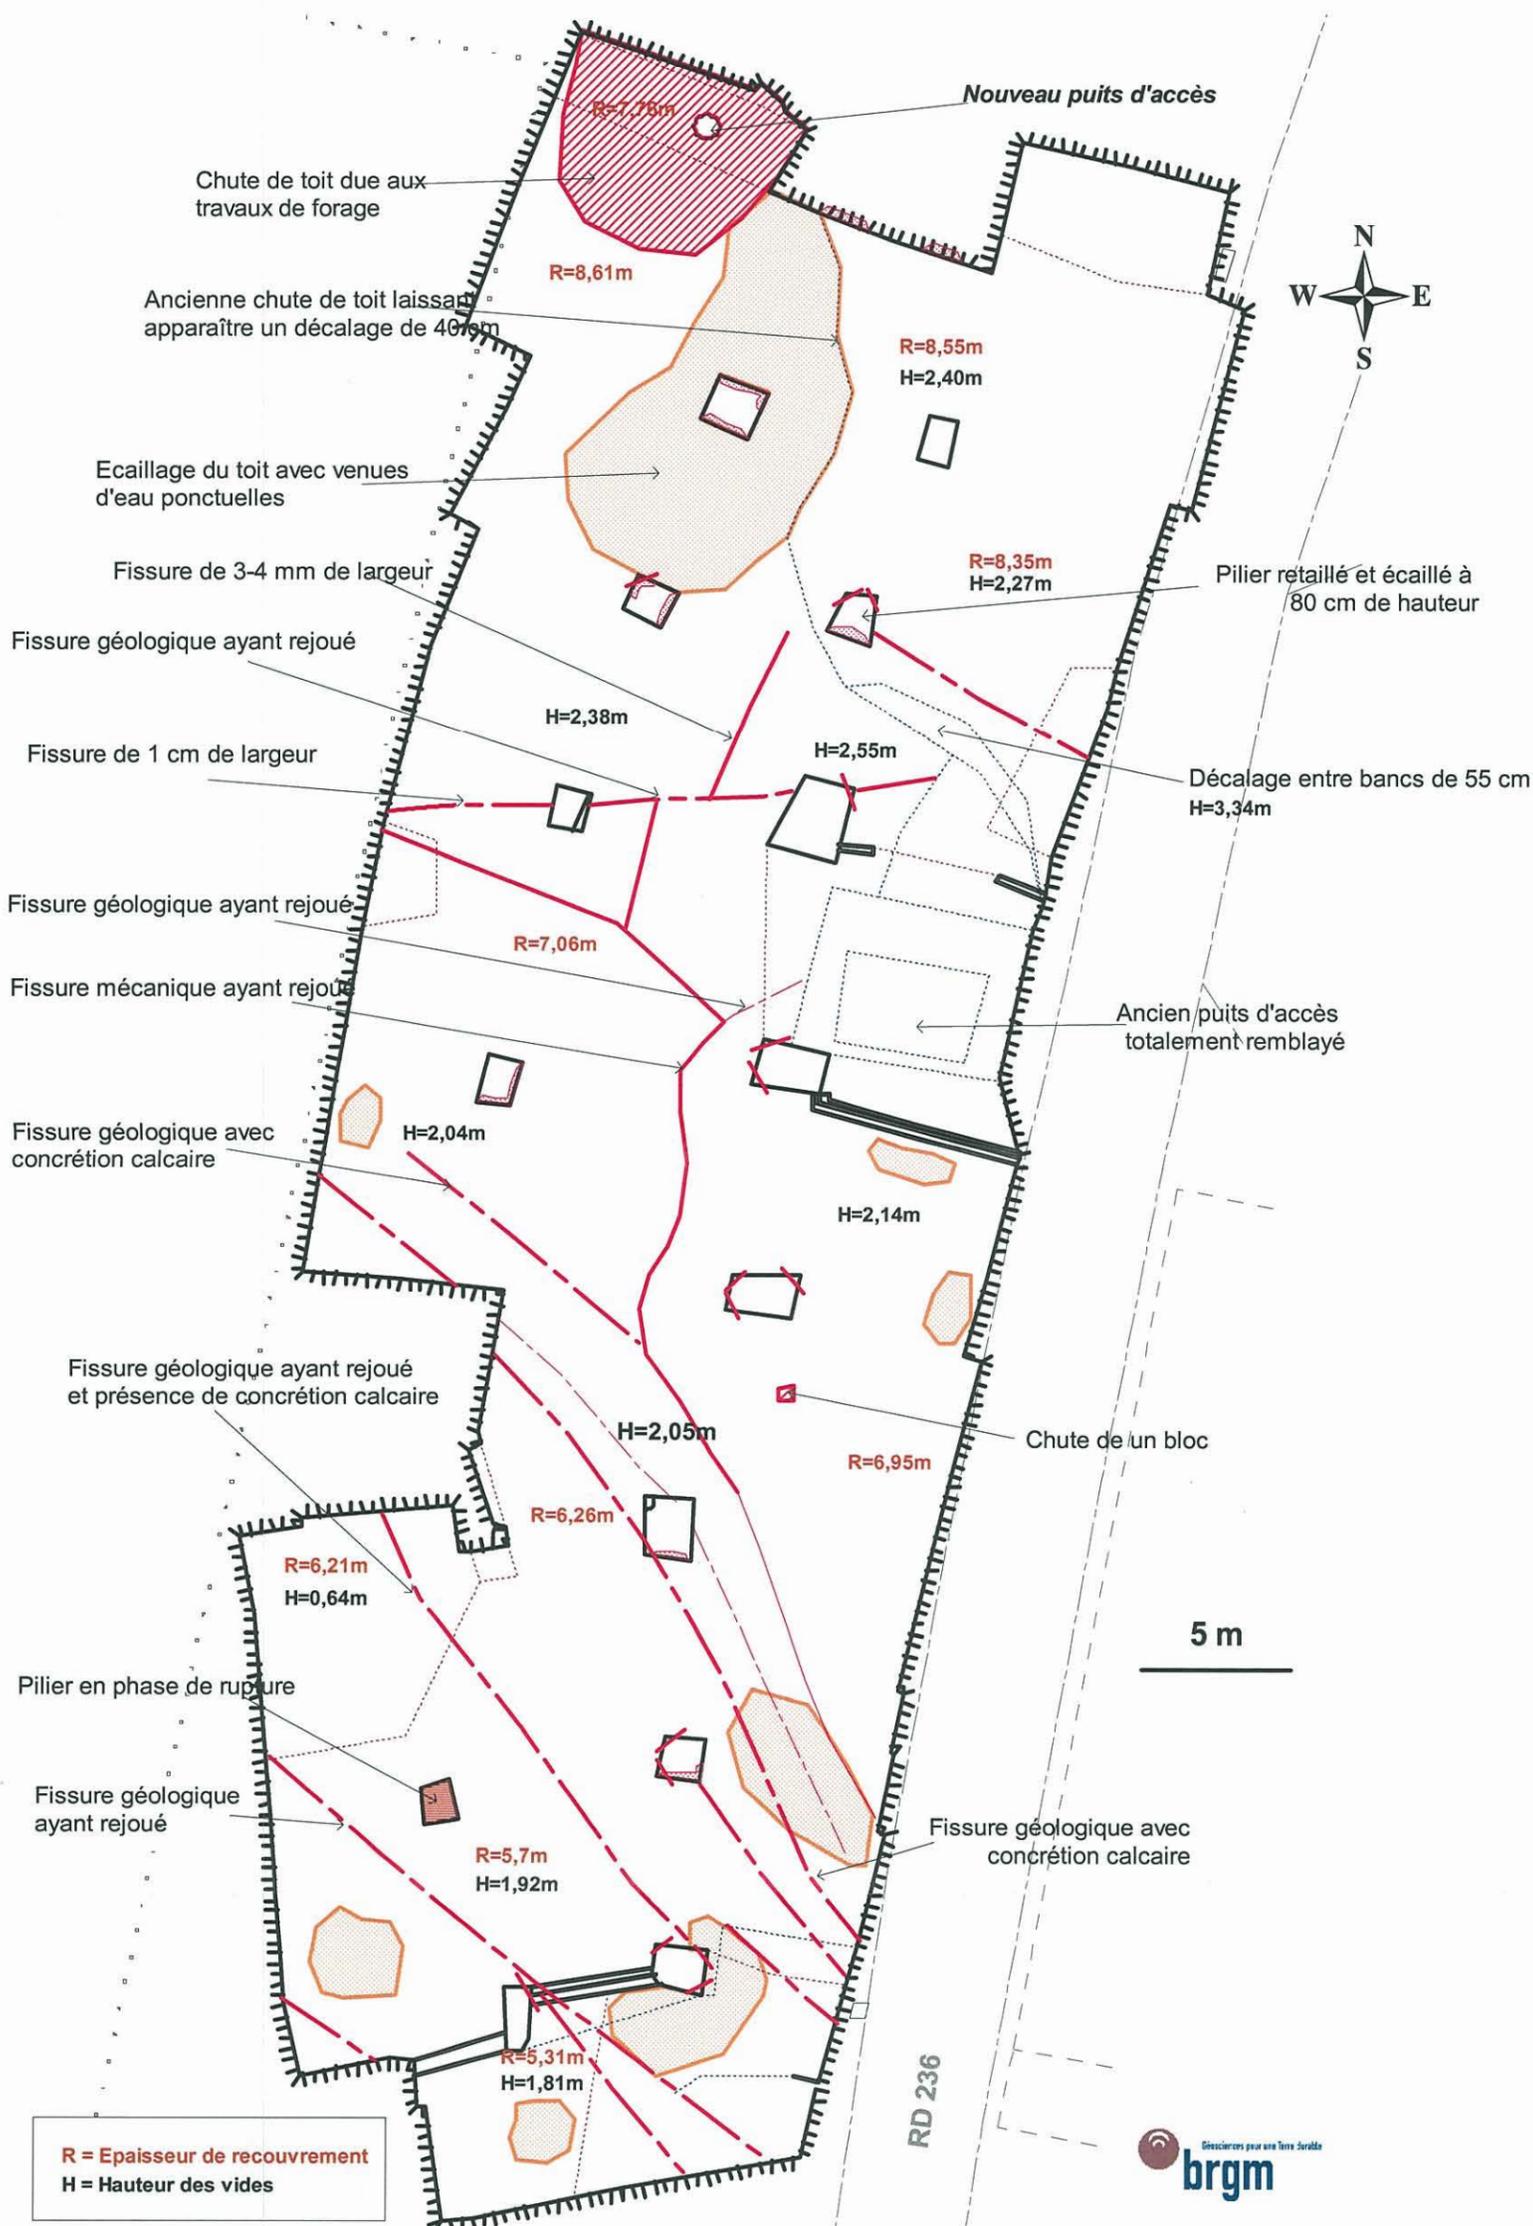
Carrière Sud-Ouest à St-Georges-des-Coteaux - Relevés géotechniques sur fond de plan levé par un géomètre-expert
